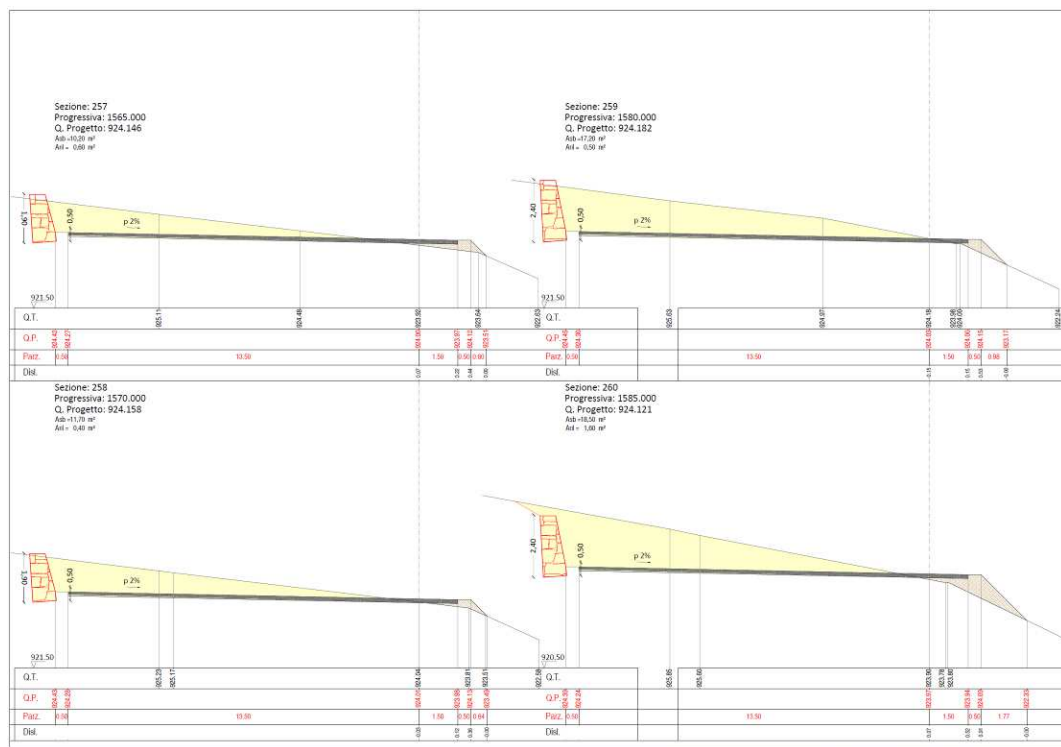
estratto sezioni di progetto tratto finale [tavola B5 Studio Maraaffio]
